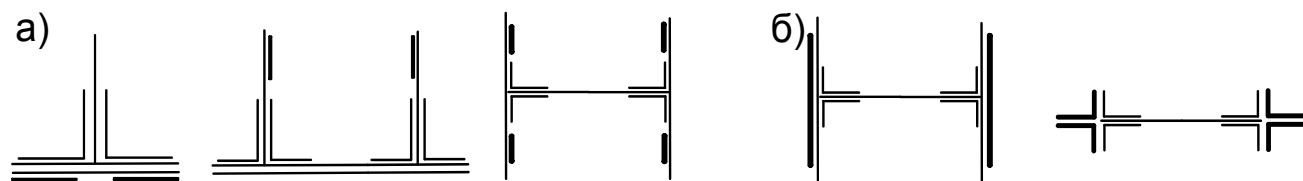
Схемы расположения металла усиления элементов: а – поясов; б – раскосов, стоек, подвесок (металл усиления показан жирными линиями)
